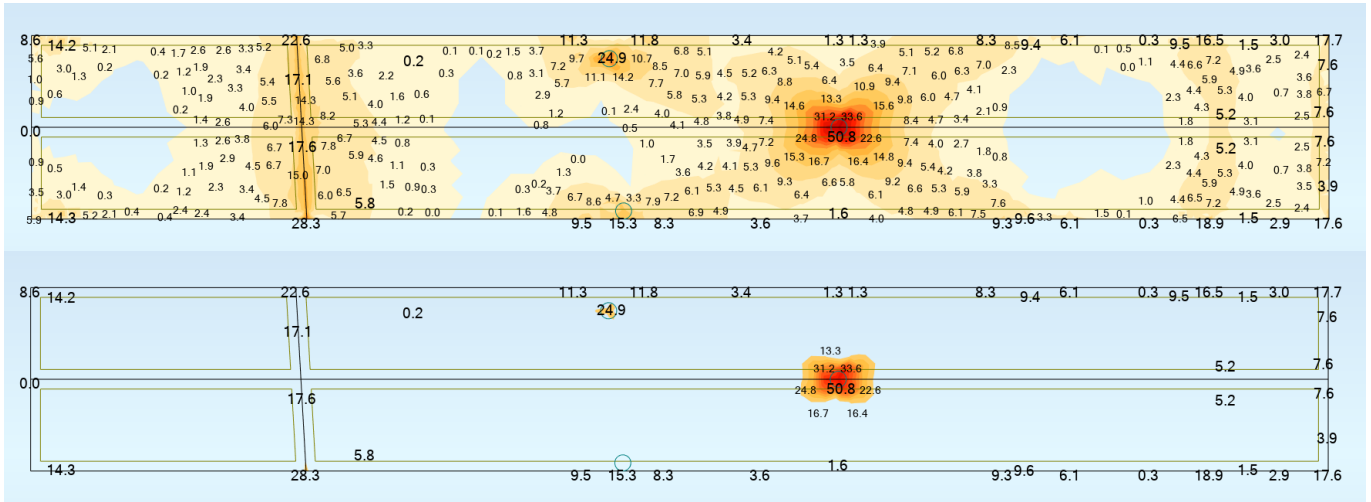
Armadura superior transversal (abajo zona reforzada)
